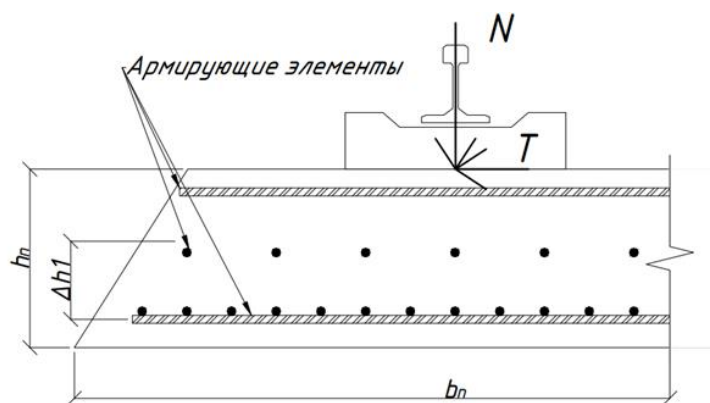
Расчетная схема плиты с армирующими элементами.
